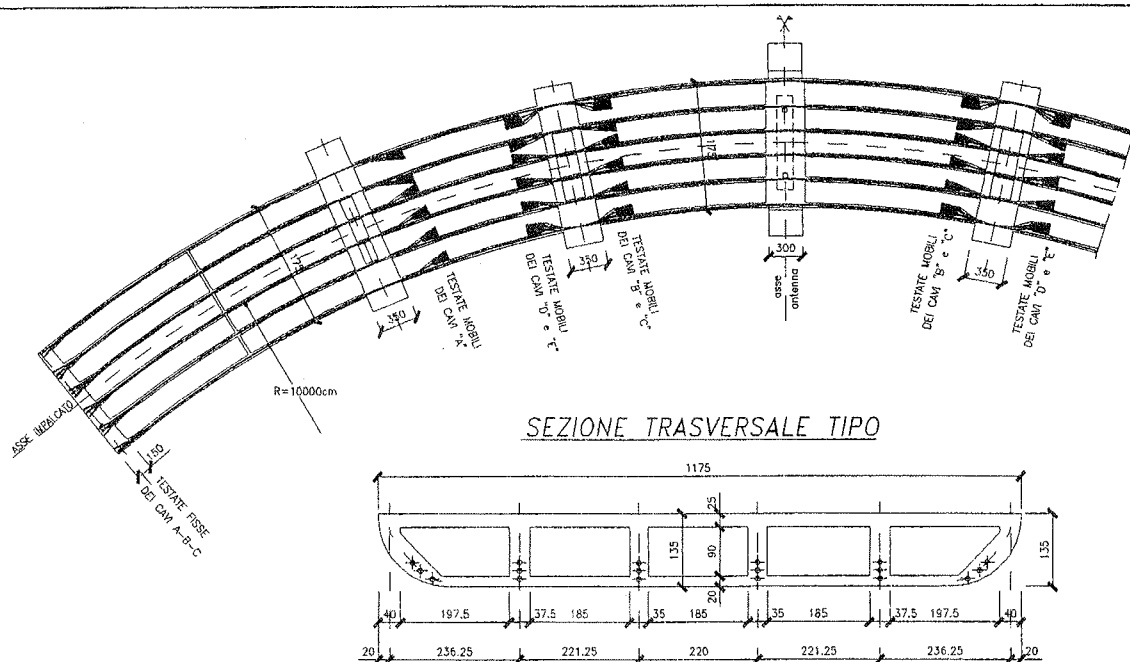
Tracciato dei cavi di precompressione in pianta e sezione tipo.
